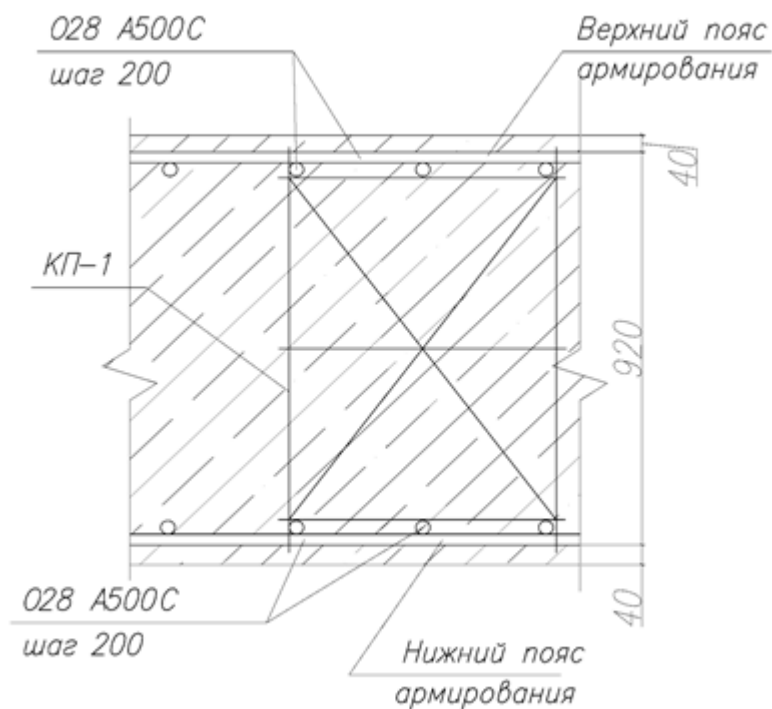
Верхний пояс армирования плиты перекрытия
